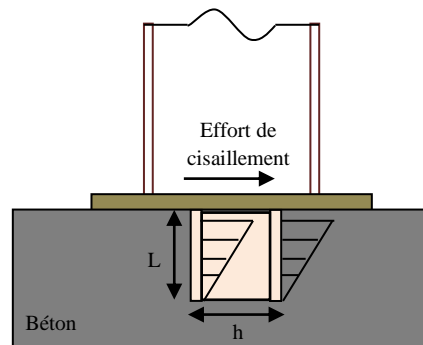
Pied de poteau avec une bêche d'ancrage
